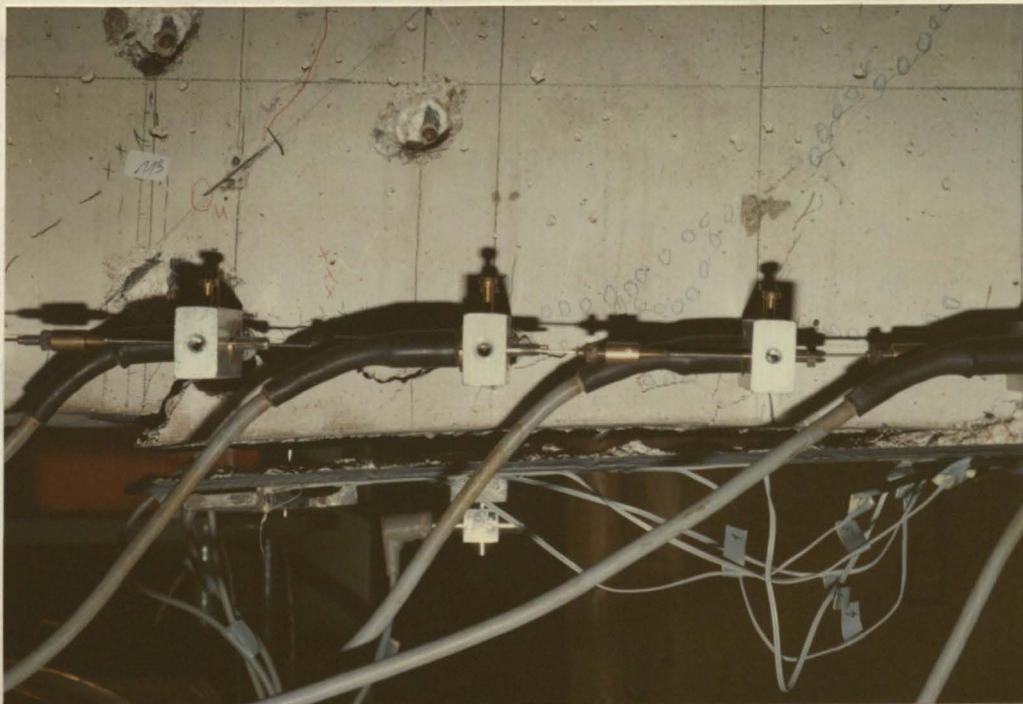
Bruch durch Bildung eines horizontalen Risses am Laschenende in Höhe der Innenbewehrung mit anschließendem Verbundbruch
